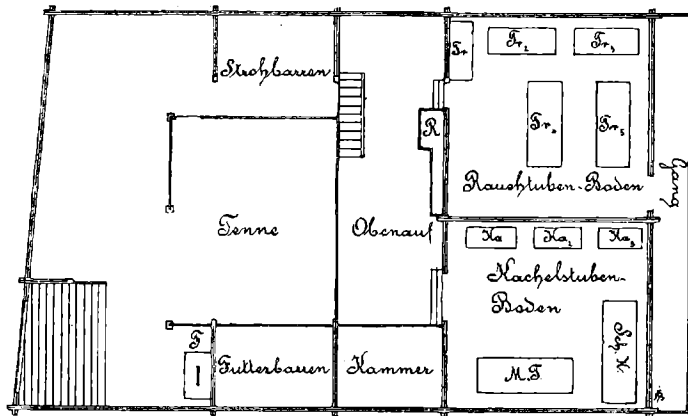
Grundriss des Erdgeschosses der Rumpler-Keusche¹⁾.
